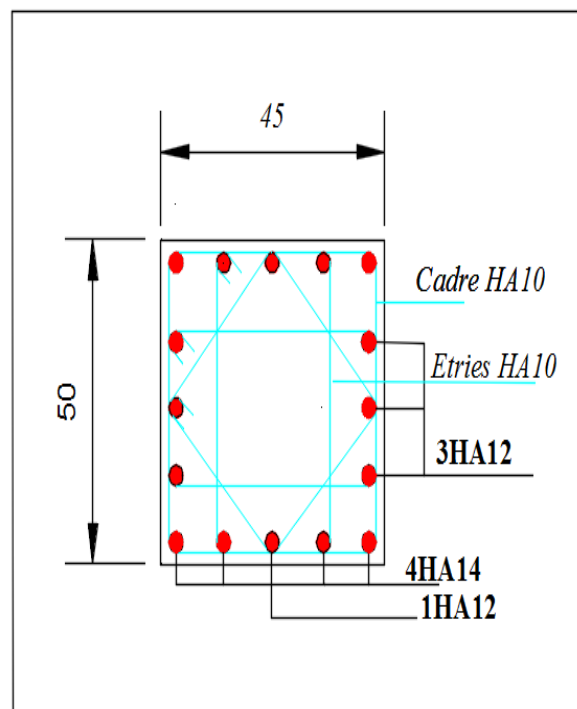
schéma de ferrailage des poteaux 8, 9^{ème} étages.
